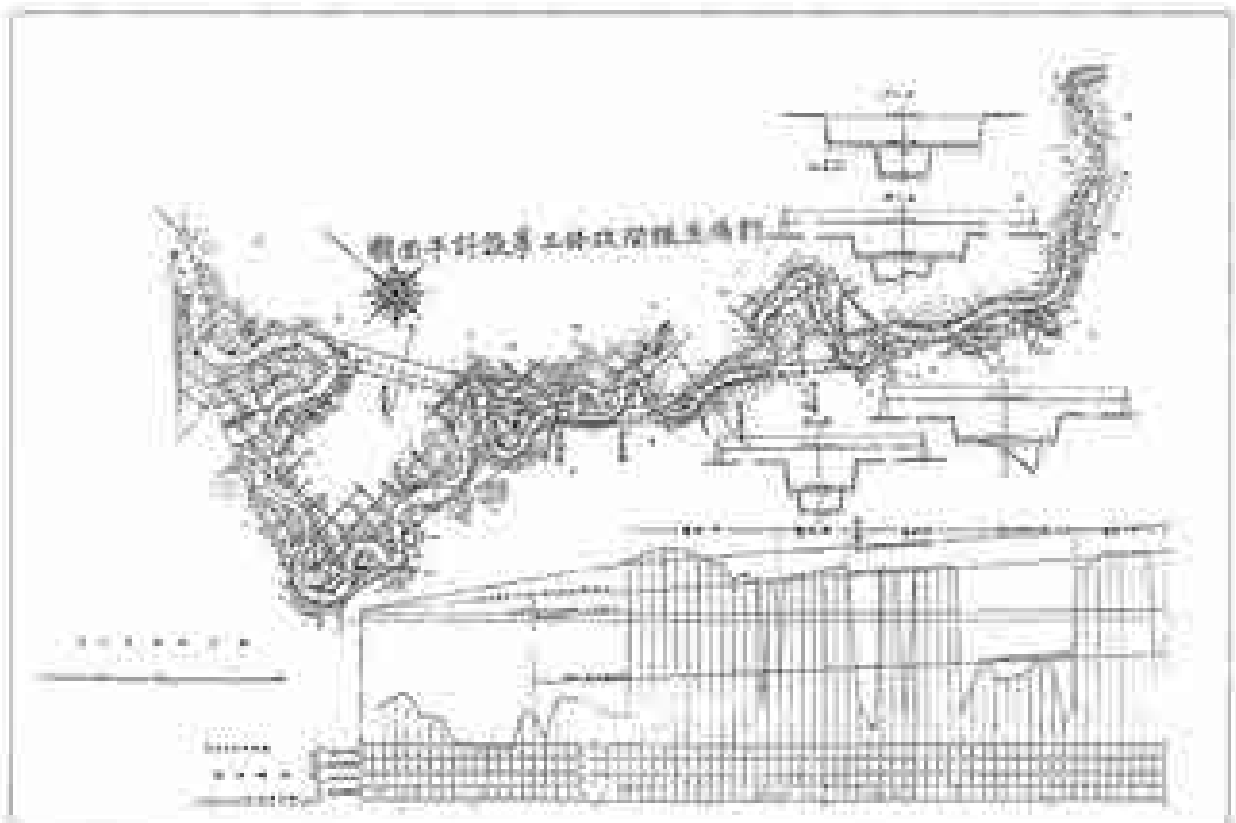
対雁生振間捷水路設計平面図（明治39年設計）
